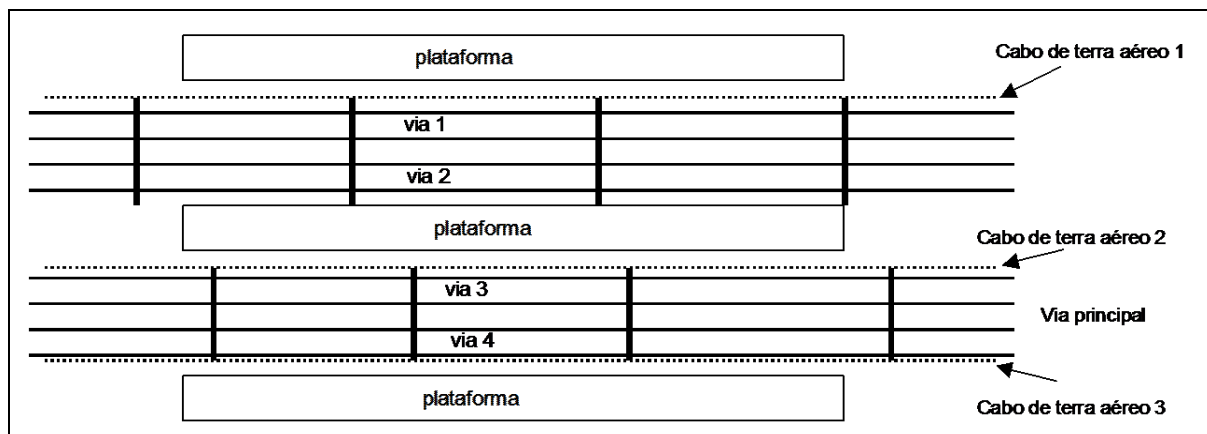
Utilização do CDTA em pórticos rígidos de estações, exemplo em planta
